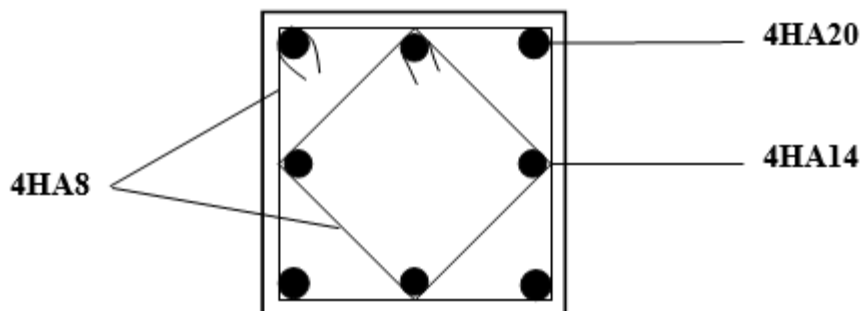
Schéma de ferrailage du poteau 1,2^{ème} étage
